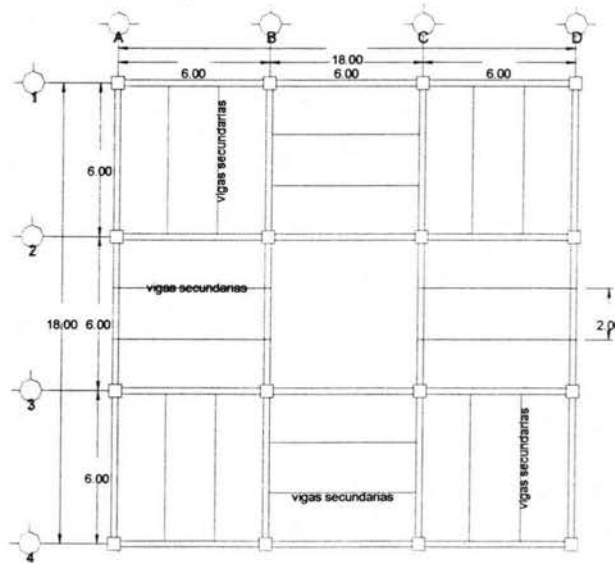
Planta Tipo del Edificio, Caso 3
